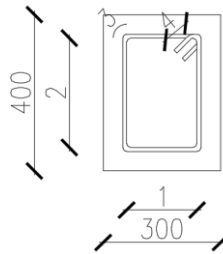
Bestat Tulangan Senggang Balok Induk
